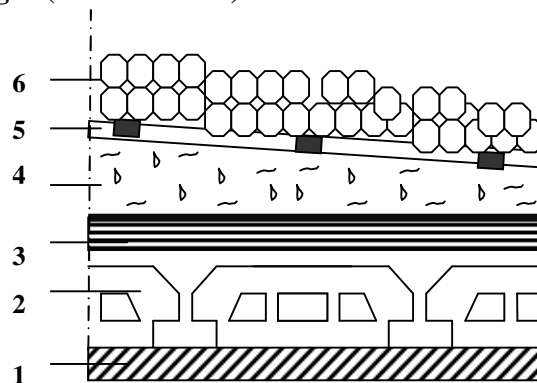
Coupe verticale du plancher terrasse inaccessible
